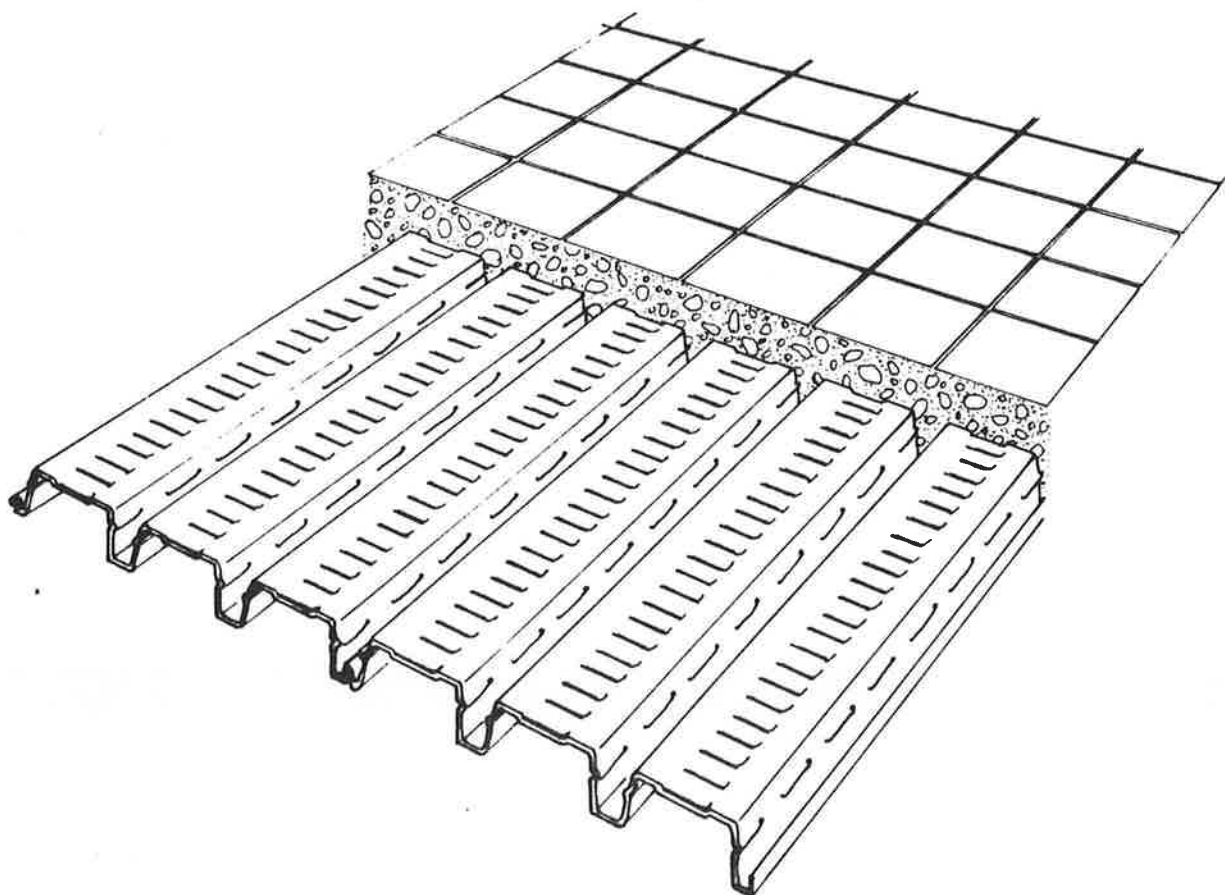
Ilustração genérica de uma laje composta concreto - chapa de aço dobrada. (1)
